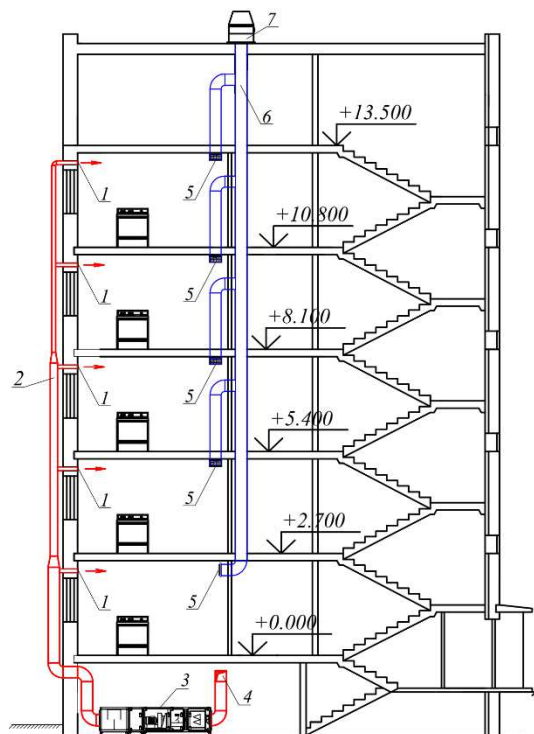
Схема приточной и вытяжной системы вентиляции жилого здания с прокладкой воздуховодов по фасаду: 1 – решетки приточной системы вентиляции; 2 – канал приточной системы вентиляции; 3 – приточная установка; 4 – забор наружного
